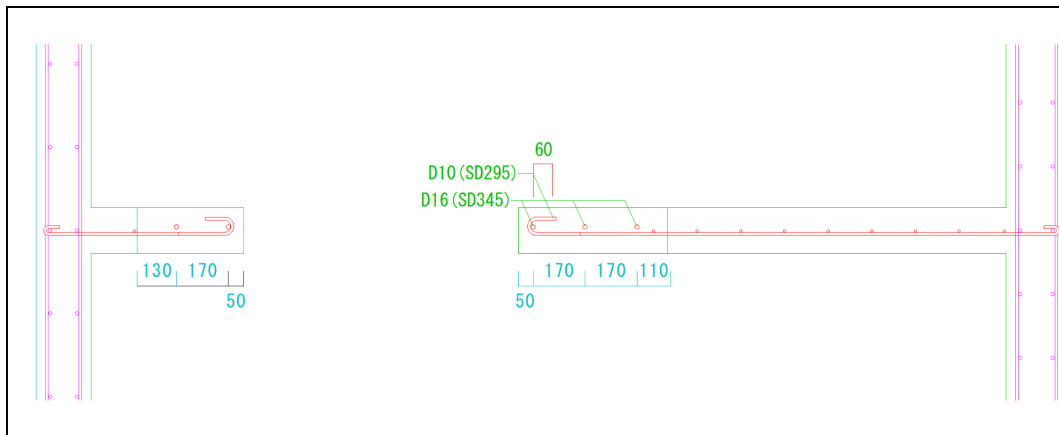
補強柱（上向きアンカー） 計画図
